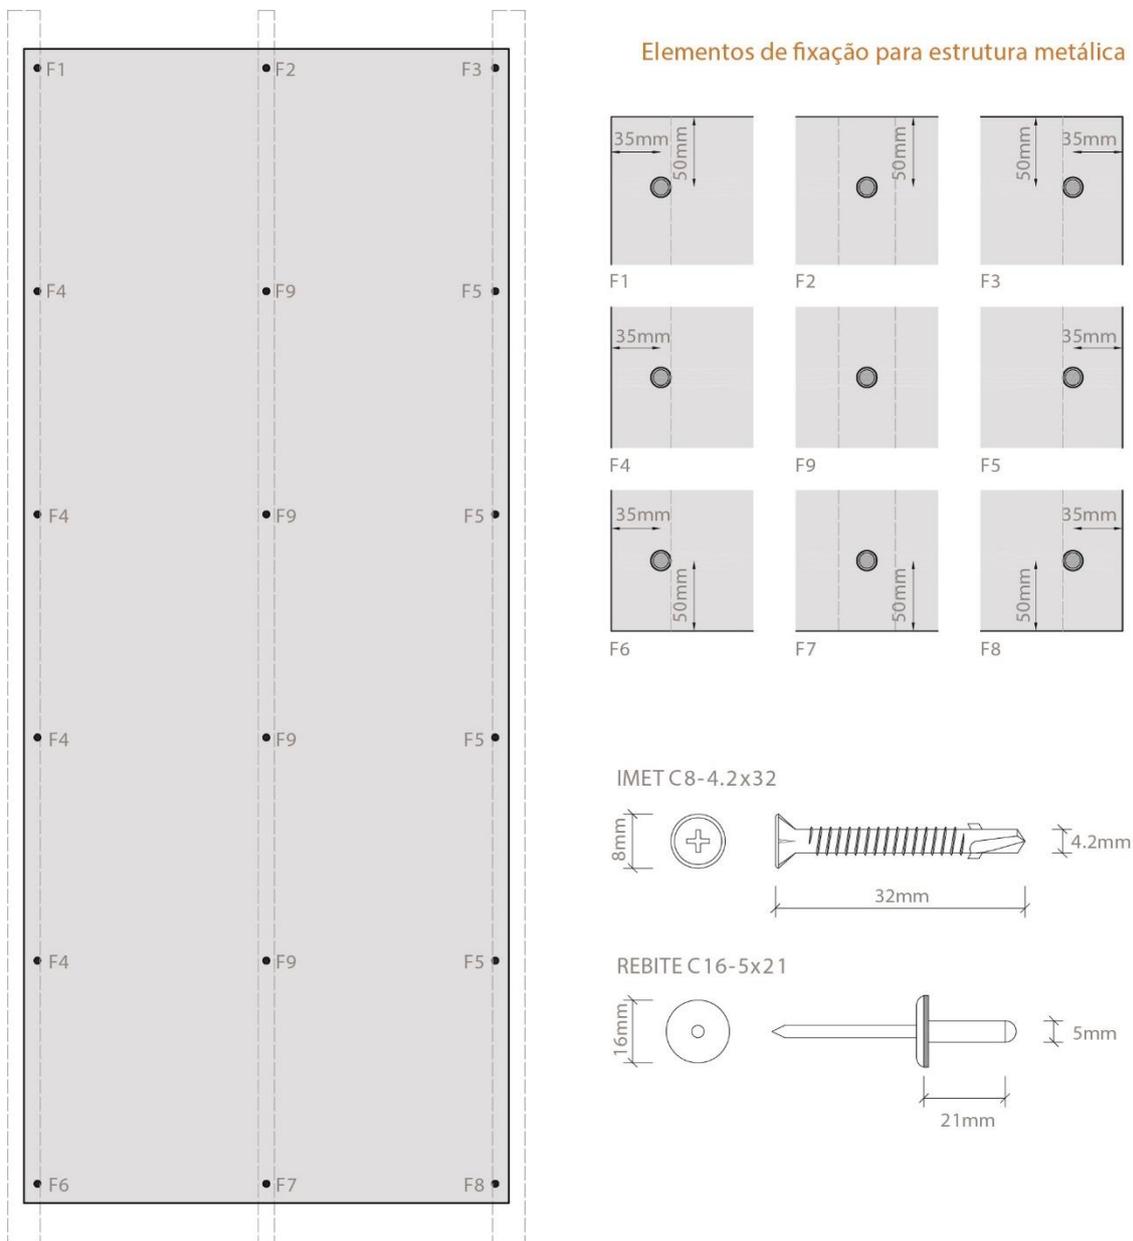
elementos tipo, de fixação da estrutura metálica
